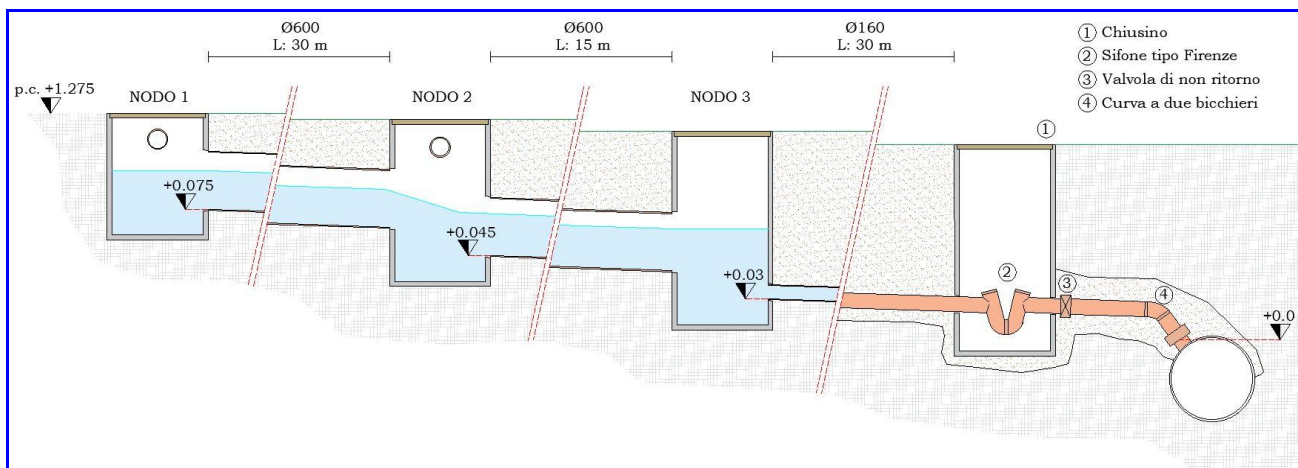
Water Elevation Profile SdF all'istante 8 ore e 49 min
